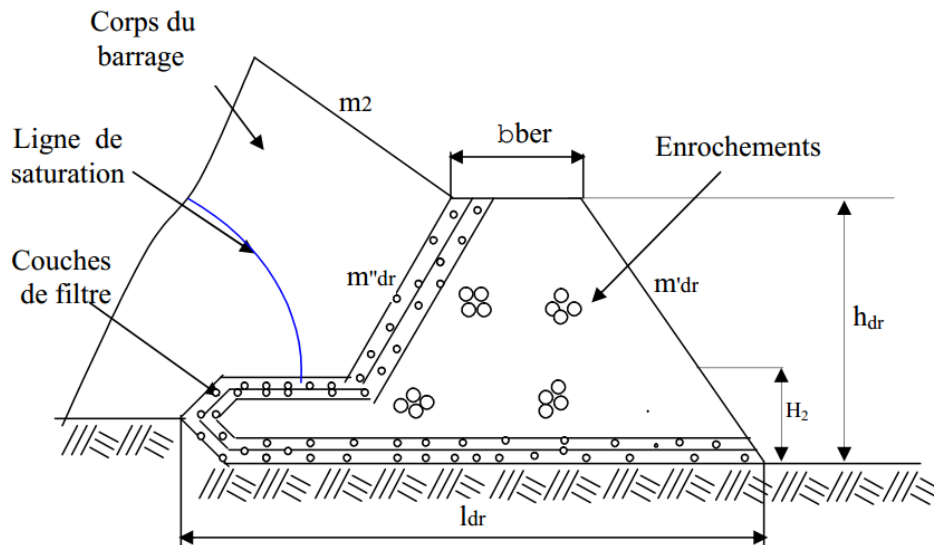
Prisme de drainage avec drain tapis interne sur fondations perméables
